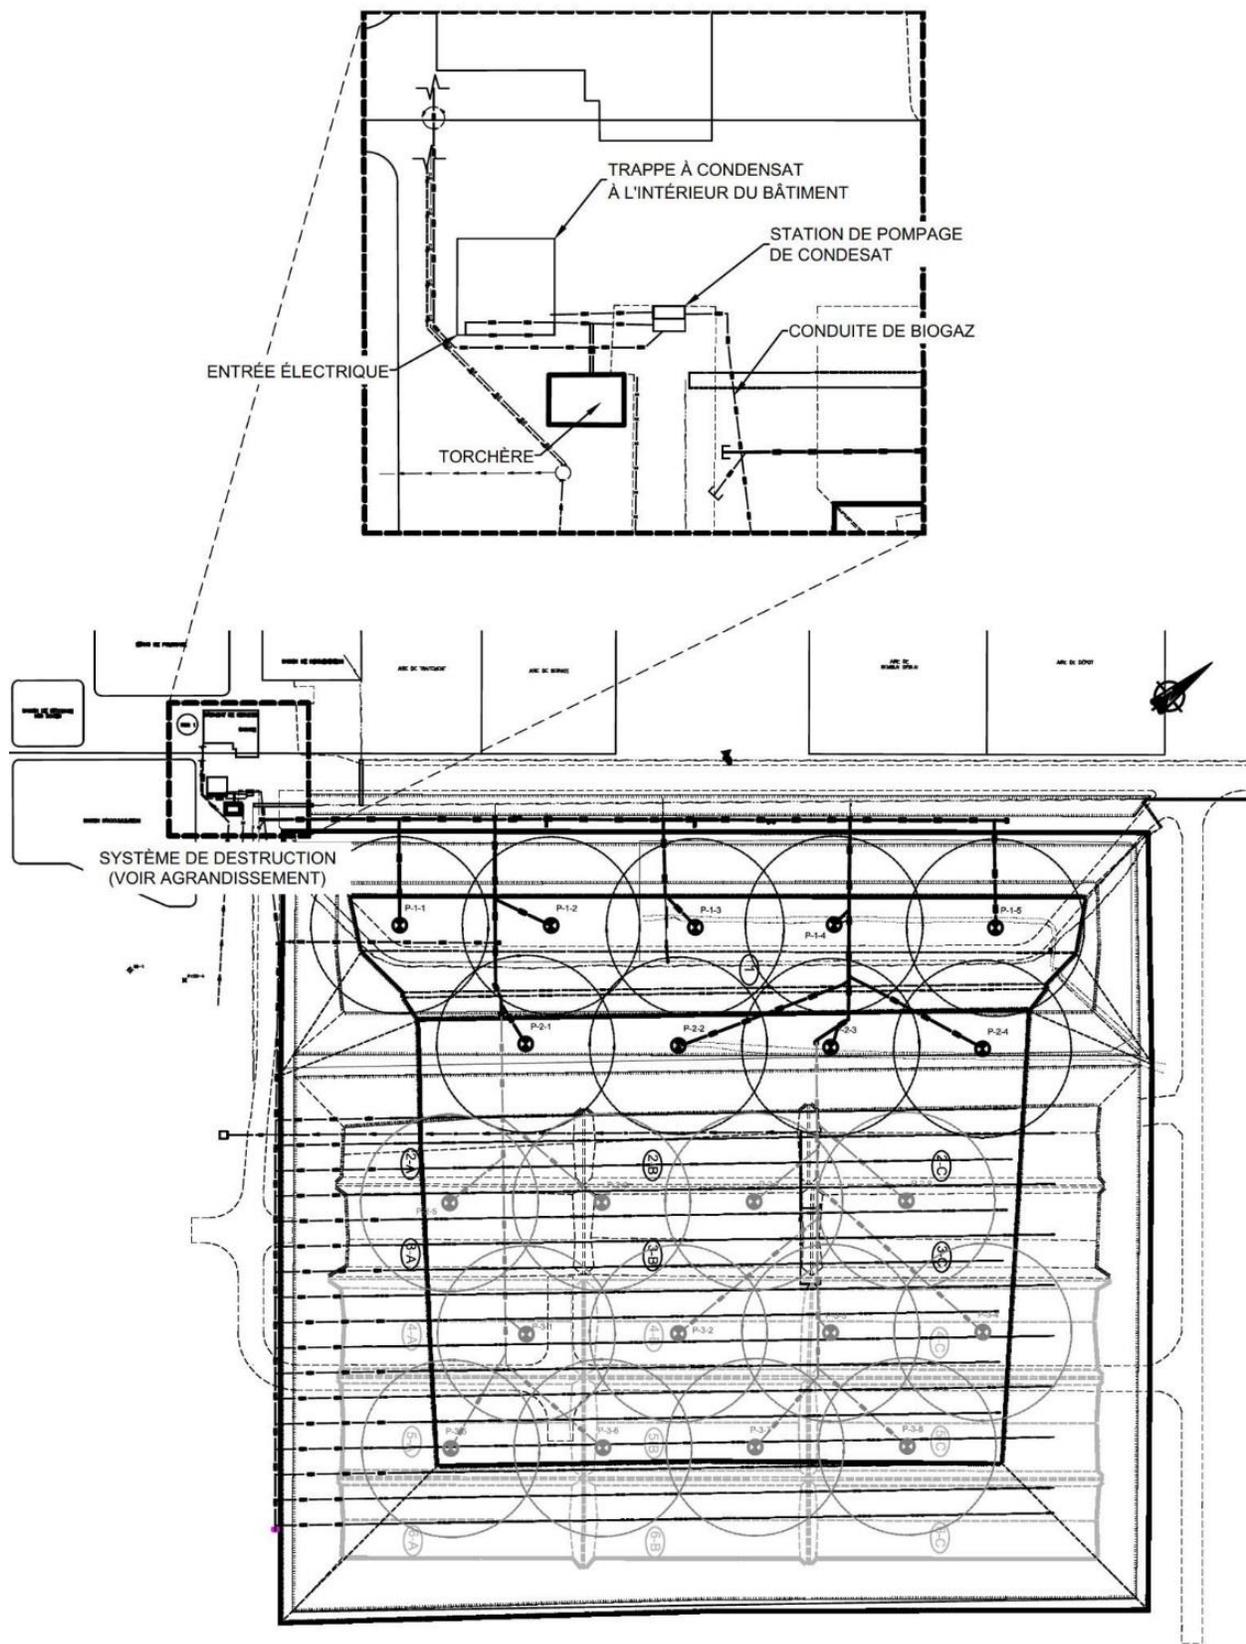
Vue en plan du lieu d'enfouissement et du système de destruction des biogaz
